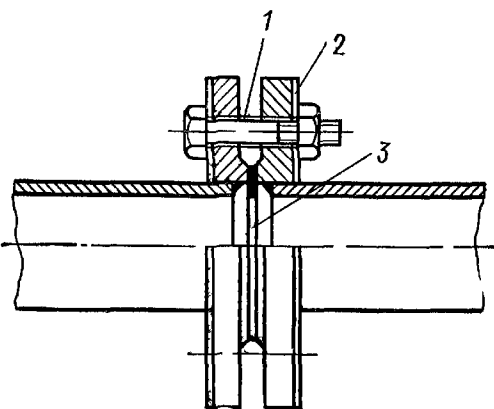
Электроизолирующее фланцевое соединение трубопроводов:
